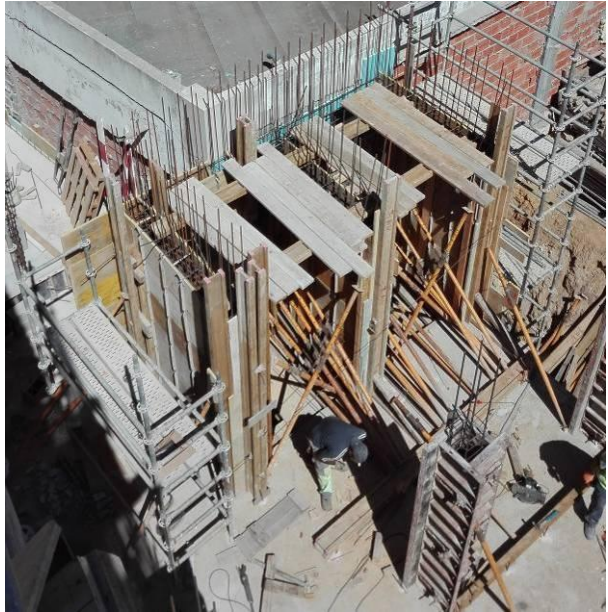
Execução de betonagem de laje e vigas do piso 0
